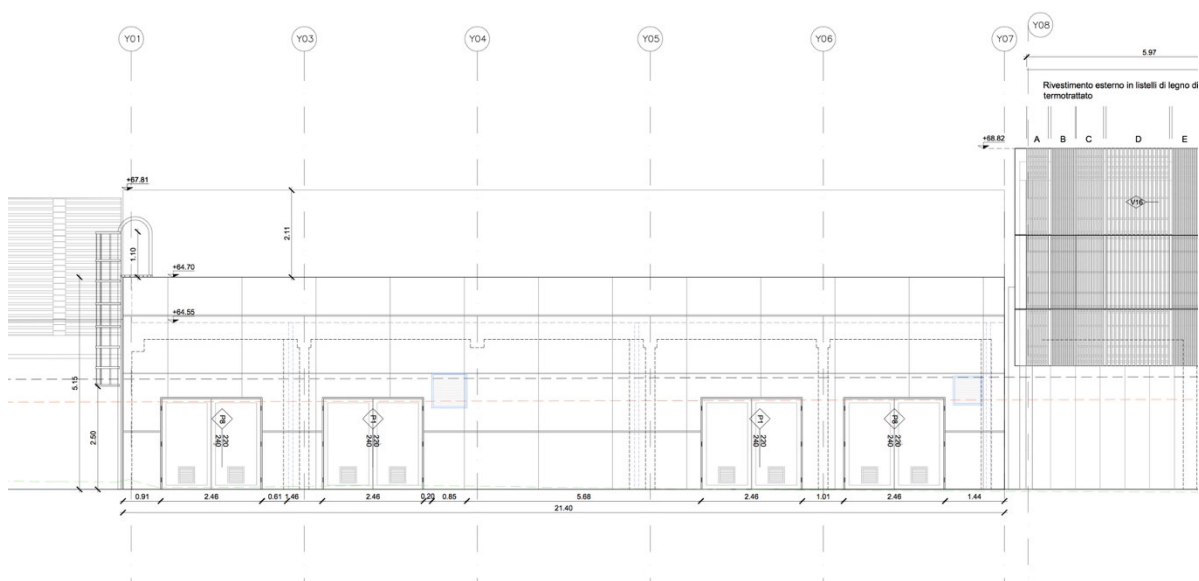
Prospetto Fabbricato FA08 (fermata Solopaca)
